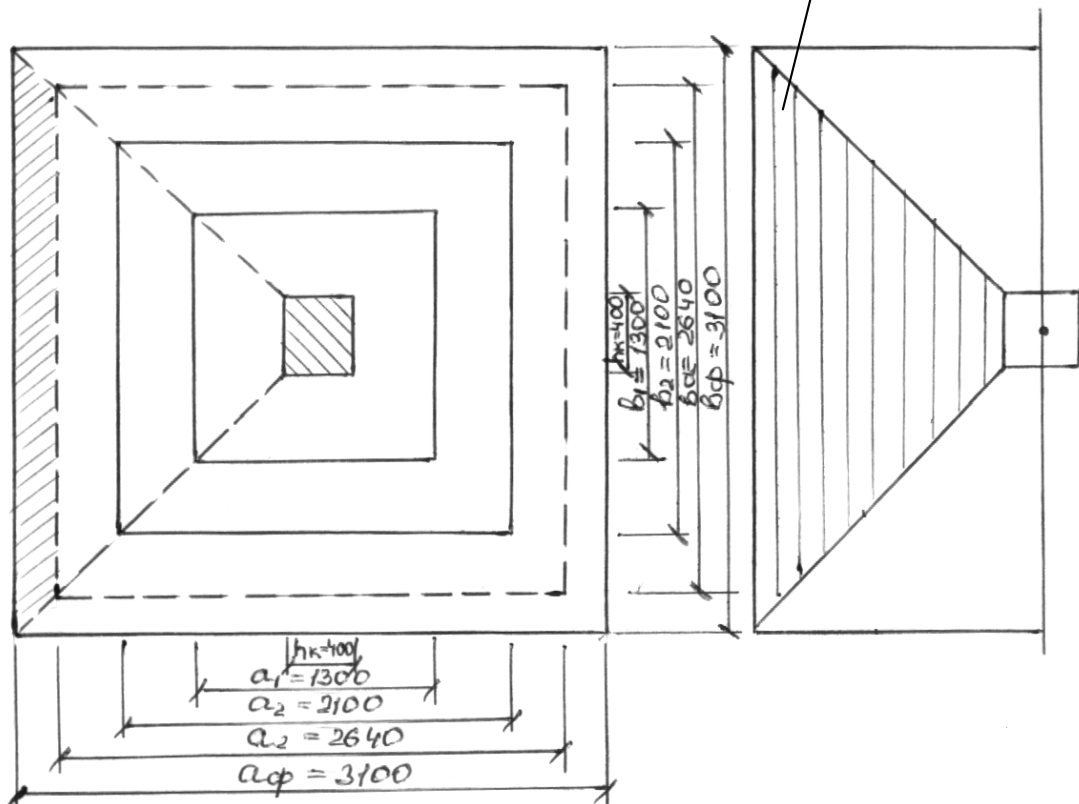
Розрахункова схема центрально навантаженого фундаменту
